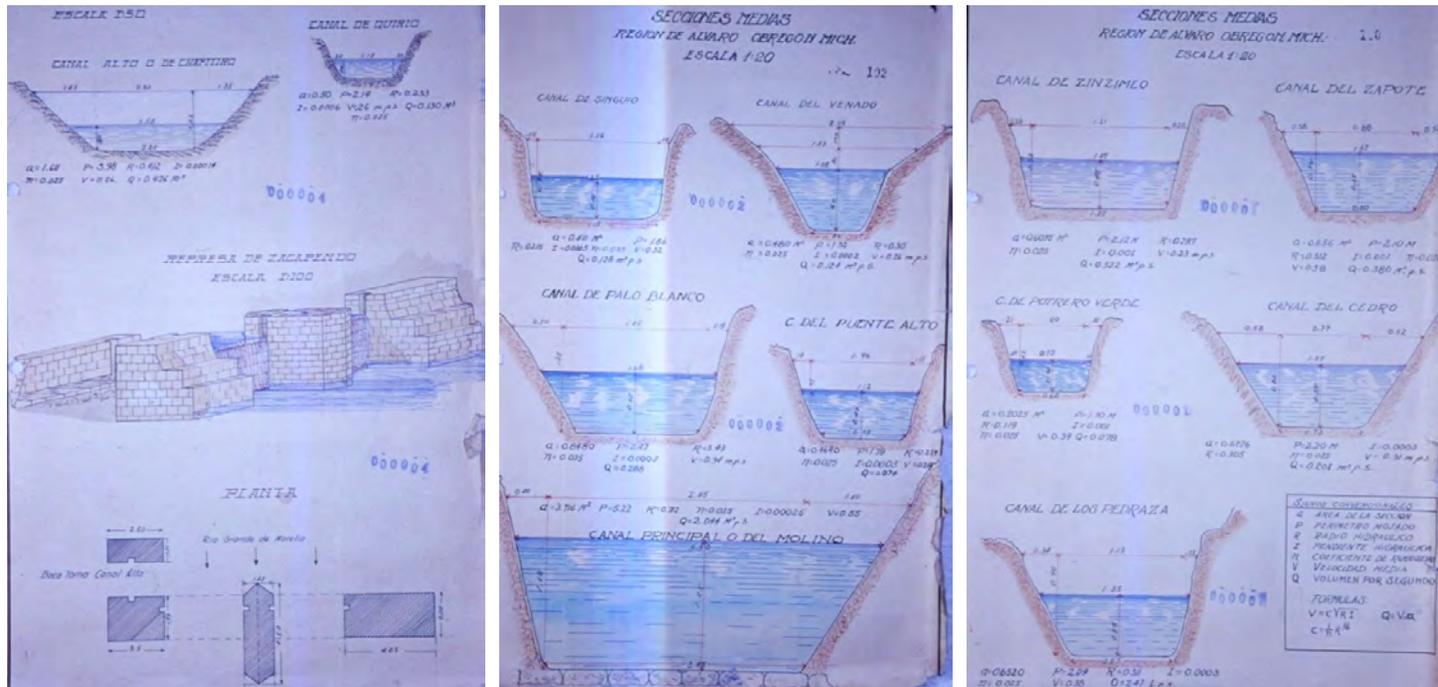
Planta y alzado de la represa de Zacapendo y cortes de los canales del sistema de riego de San Bartolo
